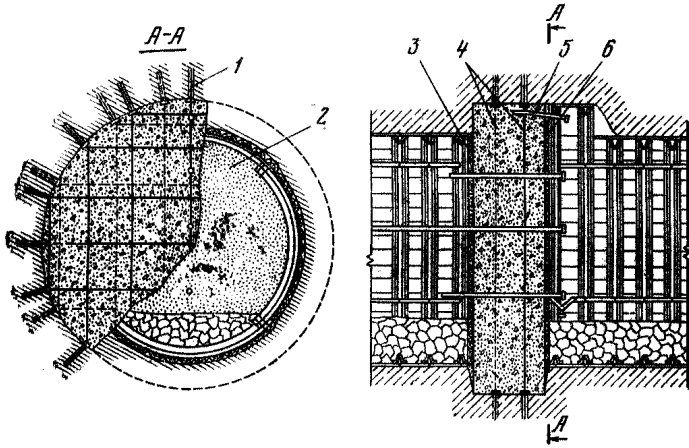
Железобетонная динамически устойчивая перемишка:
